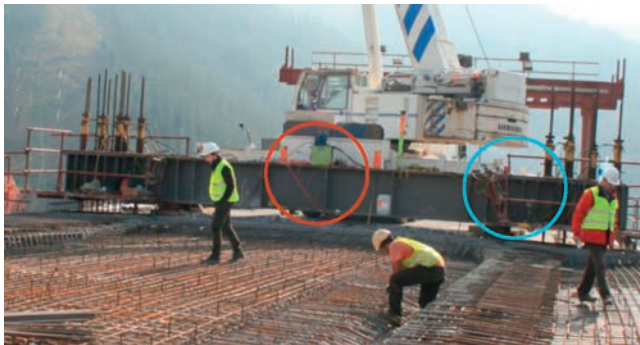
Vista de la viga transversal de cuelgue; en rojo: extensómetros en las alas en el centro de vano; en azul: extensómetro de alma junto al apoyo lateral.
